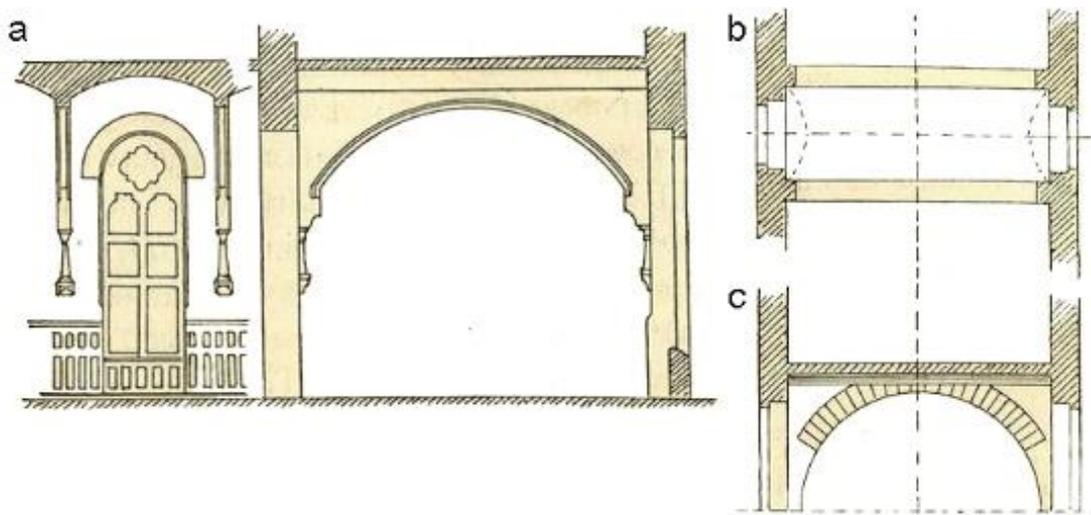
Прусский свод в перекрытии жилого помещения: а – общий вид прусского свода в интерьере; б – план; с – разрез [32]
